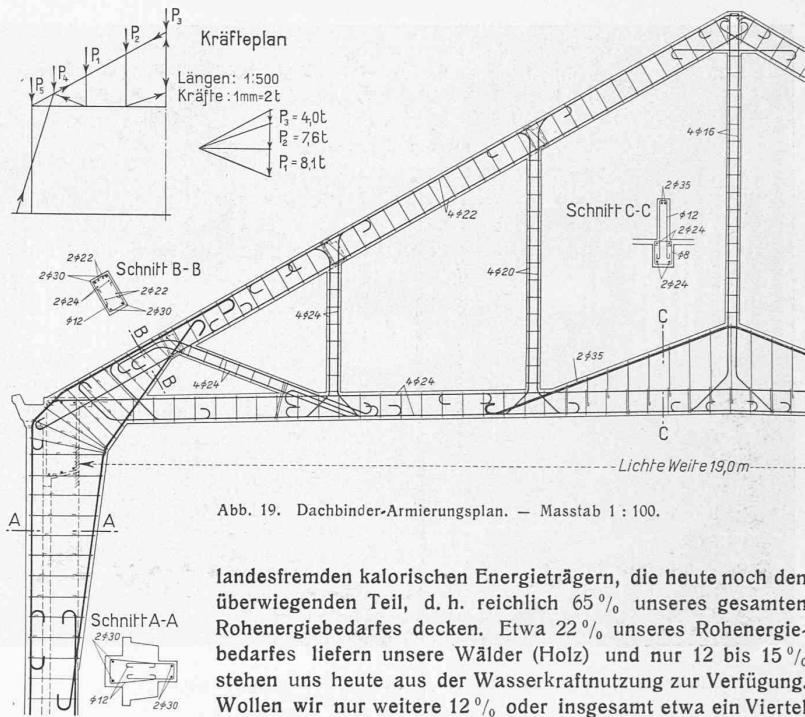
Dachbinder-Armierungsplan. — Masstab 1 : 100.
